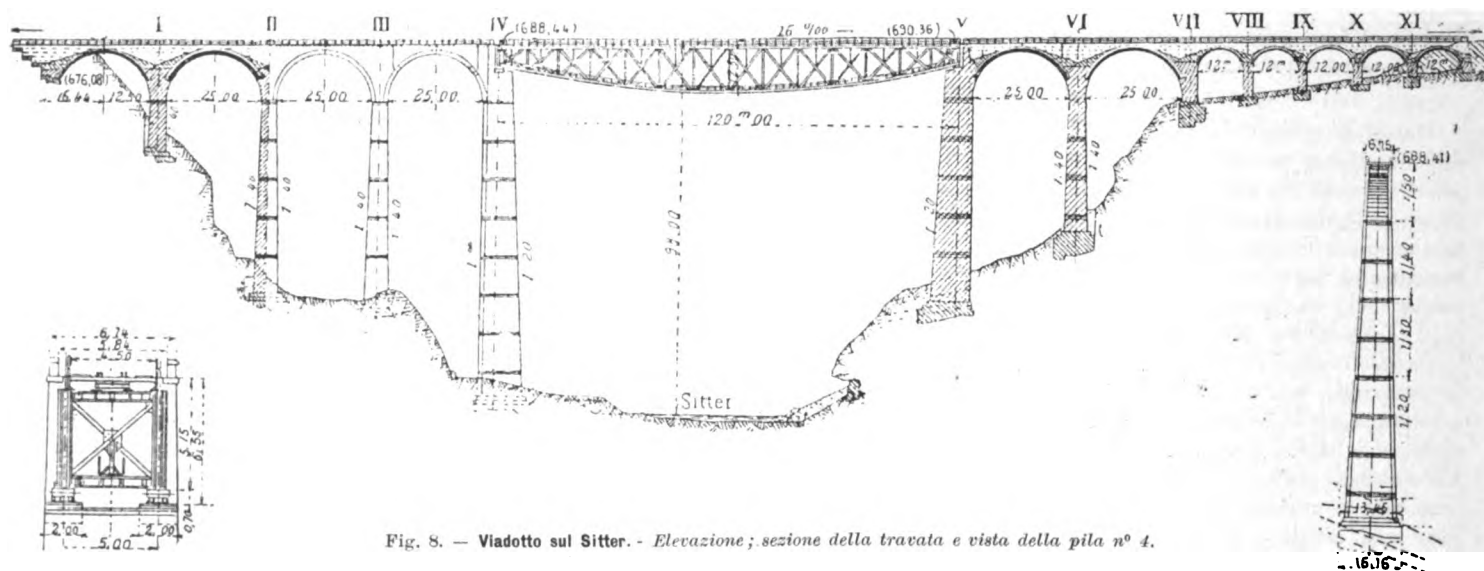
Viadotto sul Sitter. - Elevazione; sezione della travata e vista della pila n° 4.
